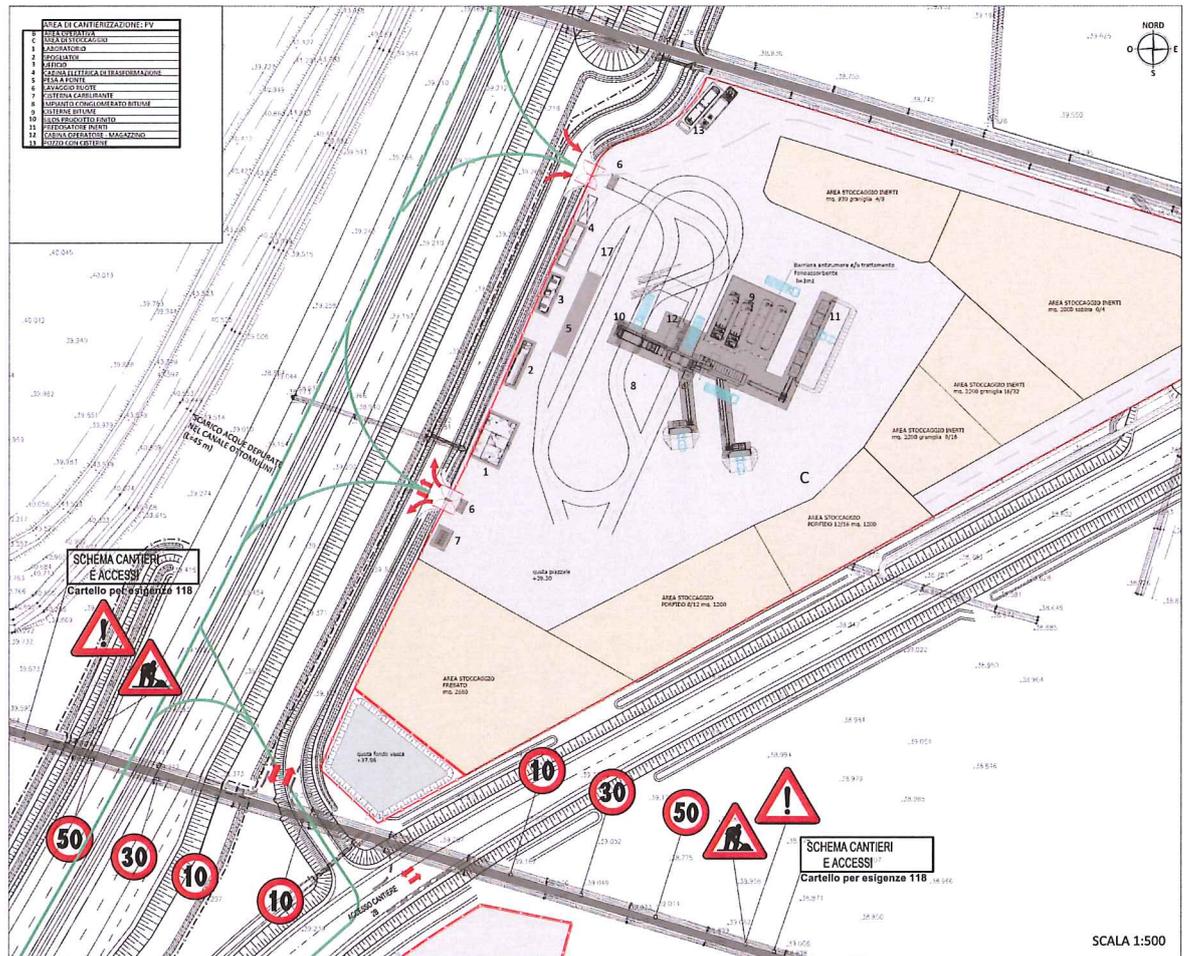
ACCESSI AL CANTIERE, DISPOSIZIONE FABBRICATI E FINITURE SUPERFICIALI ALL'INTERNO DEL CANTIERE PV
